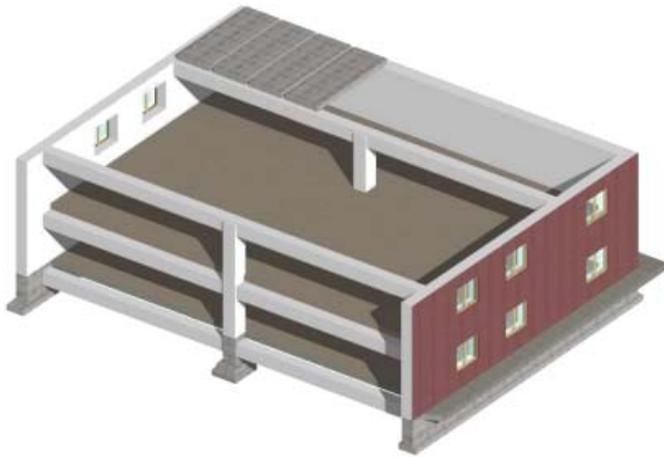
Конструктивна схема будівлі з неповним каркасом при поперечному розташуванні ригелів
